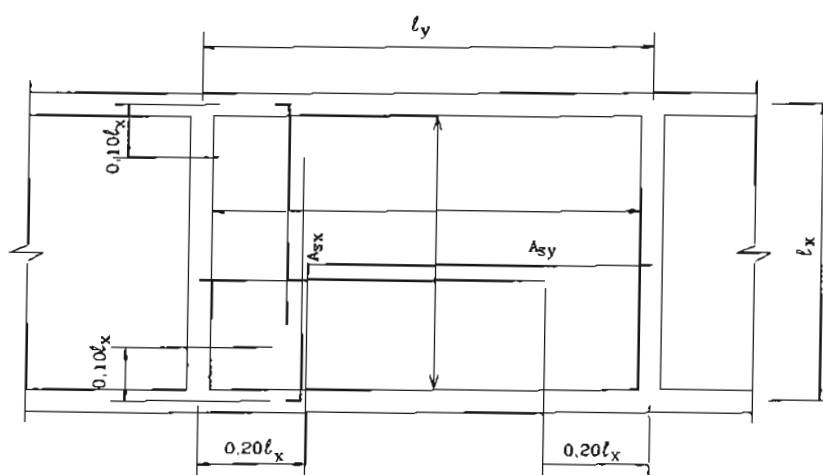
Comprimento das barras longitudinais para vão central
